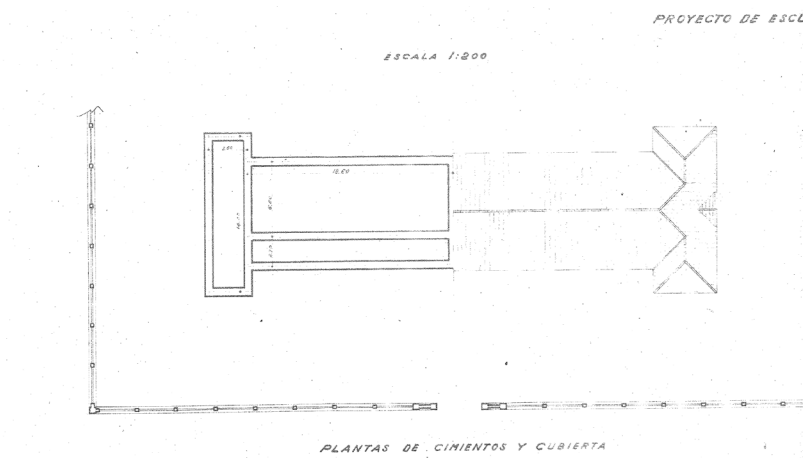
Plano de “Reconstrucción y Reforma”. Planta Proyecto de Construcción de Escuelas para Medellín (Badajoz)
